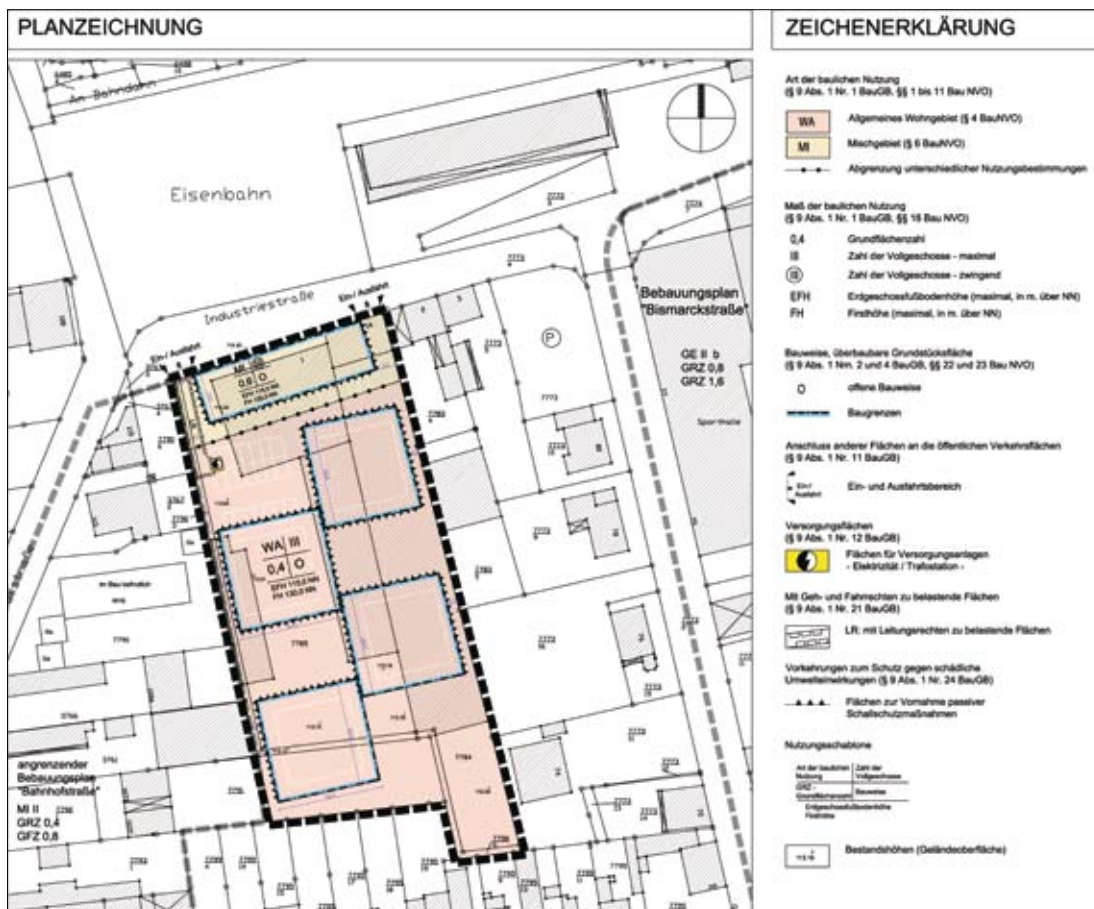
Bebauungsplan für die ehemalige Raiffeisenfläche (südlich der Industriestraße)
